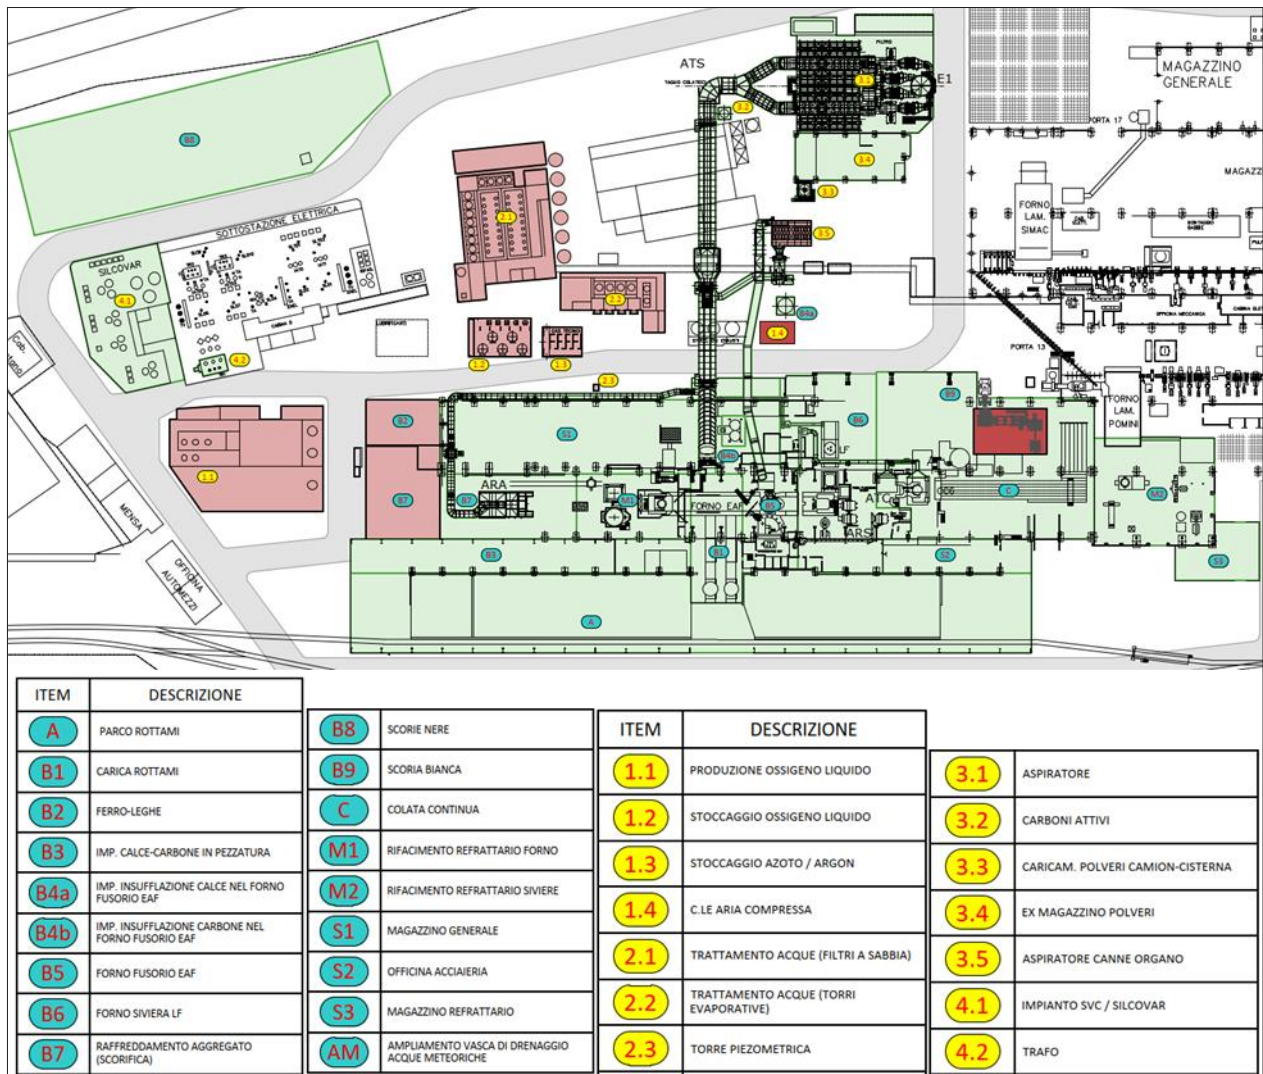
PLANIMETRIA DELL'IMPIANTO IN PROGETTO
